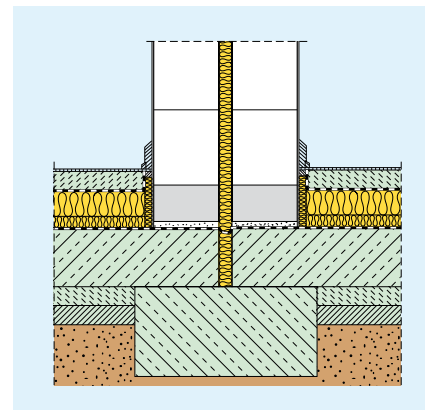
Fundamentanschluss einer zweischaligen Haustrennwand
